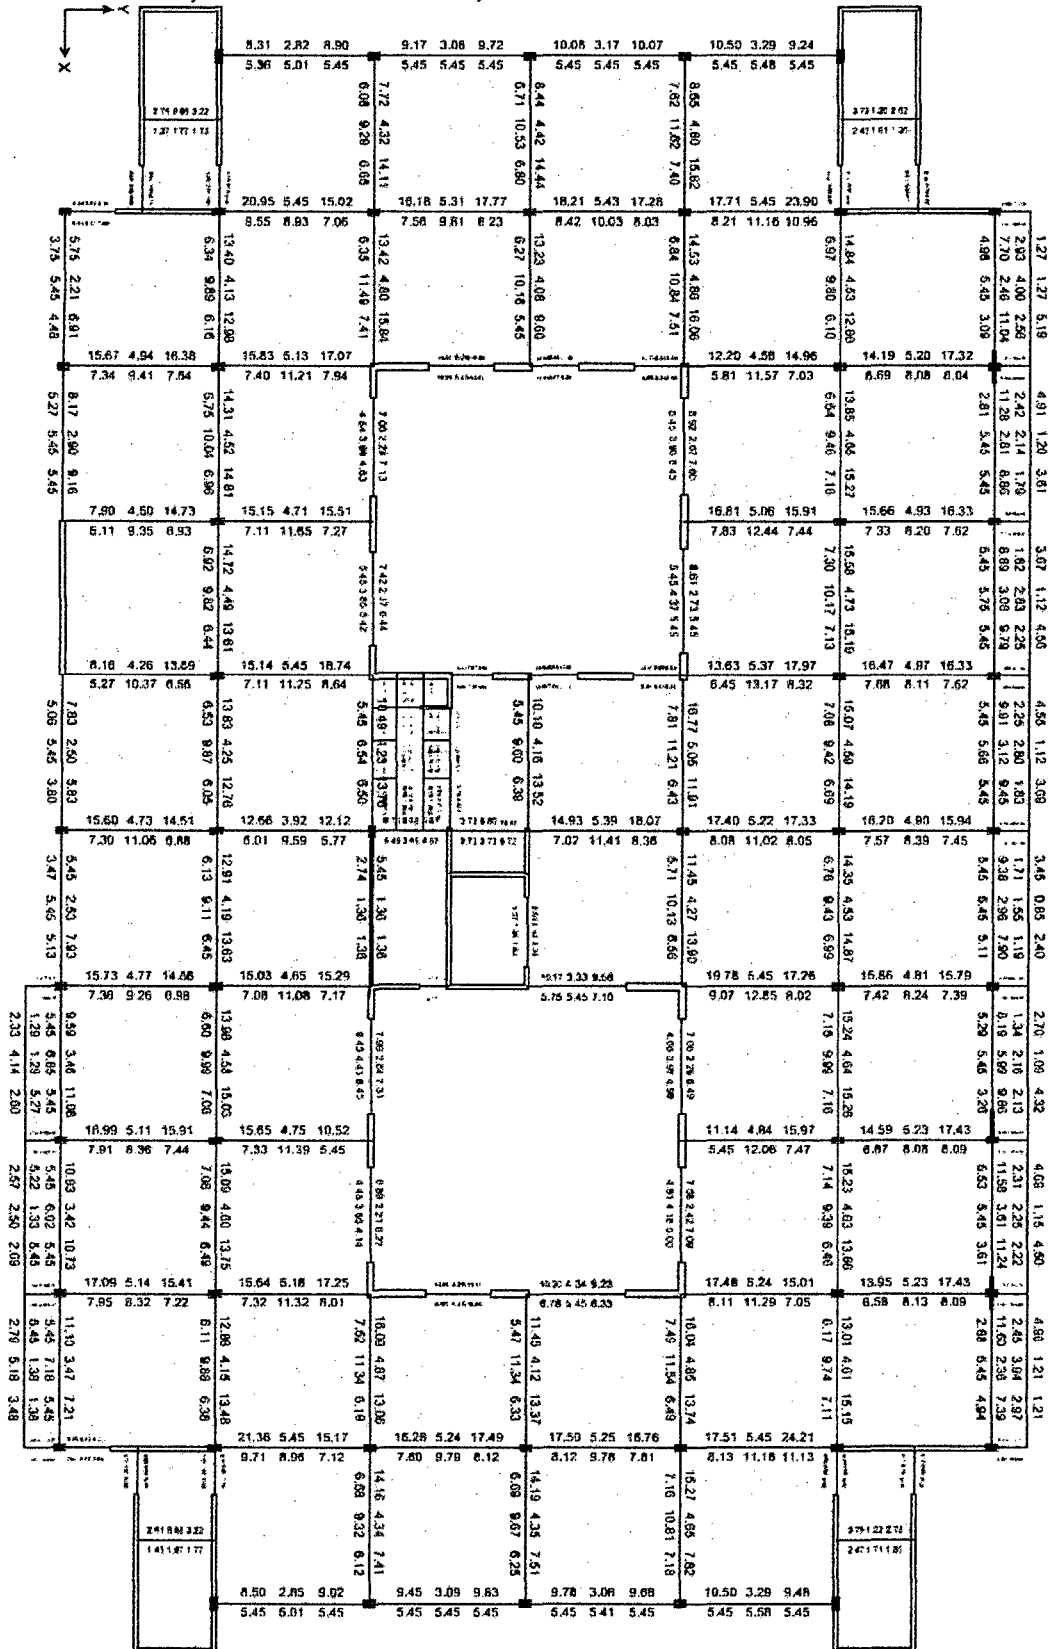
, Estructura convencional, Verificación de elementos estructurales - Piso 3.
